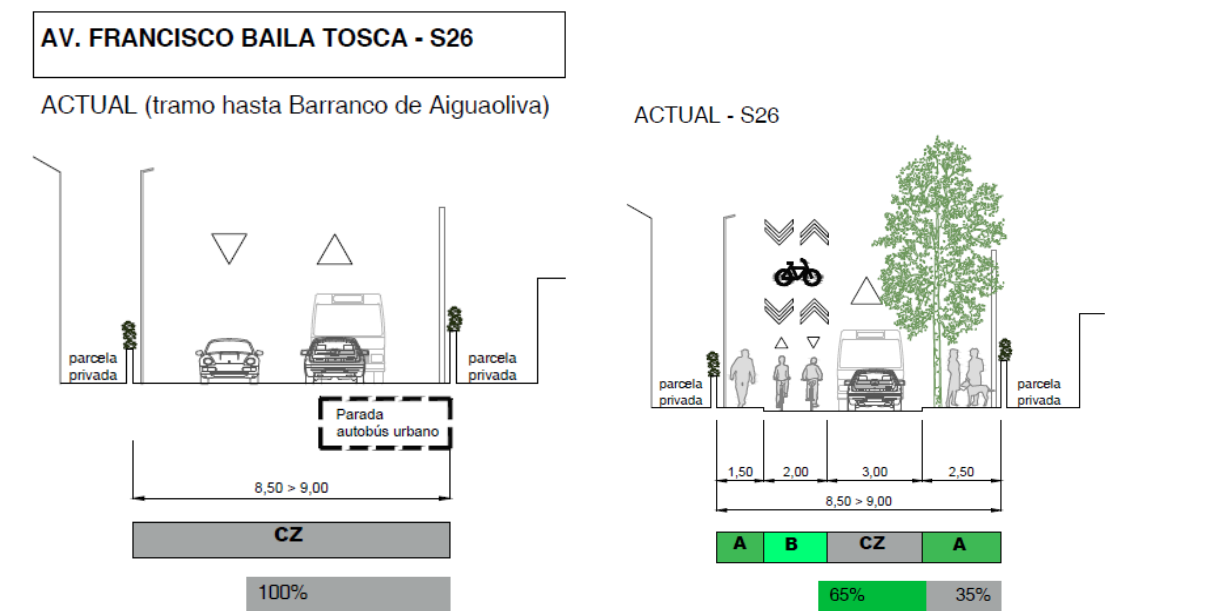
Sección Av. Francisco Baila Tosca (S26) existente y propuesta. Fuente. Elaboración propia
